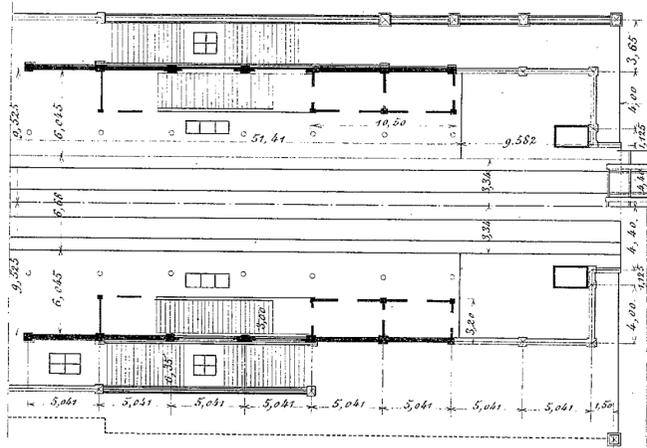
(Ech. 1/200) Coupe suivant ab. (Fig. 1).
